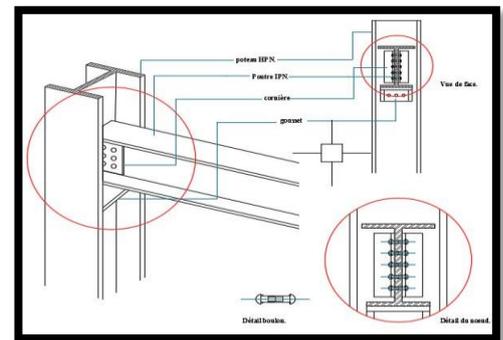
assemblage boulonné d'une poutre à l'âme d'un poteau (1/2)
